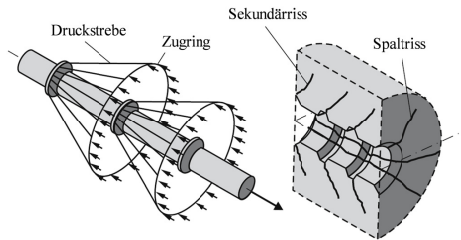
Ausbreitung der durch Verbund eingeleiteten Druckspannungen und Spaltrissbildung in der Betonschale bis zur Oberfläche des Betons, aus [Zil-06]
